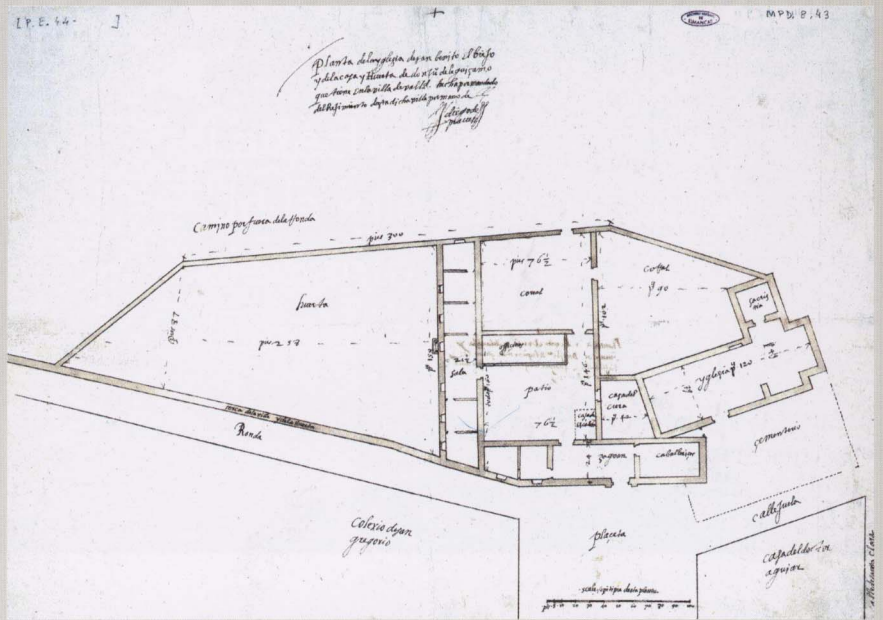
Planta del Palacio de Leguizamón, por Diego de Praves, 1595
